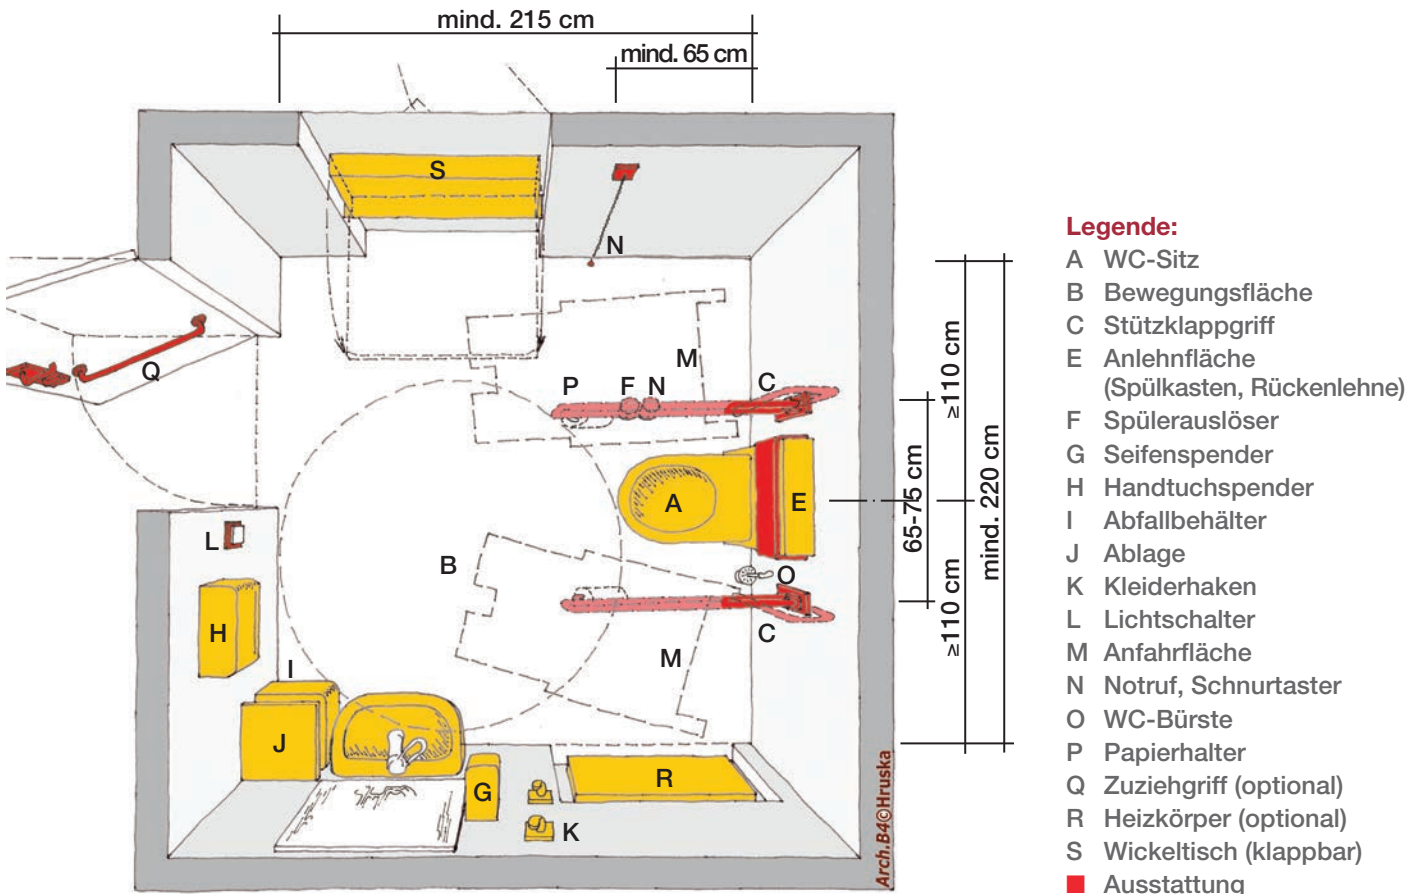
Grundriss mit beidseitig anfahrbarem WC-Sitz.Variante mit Handwaschbecken und klappbarem Wickeltisch
